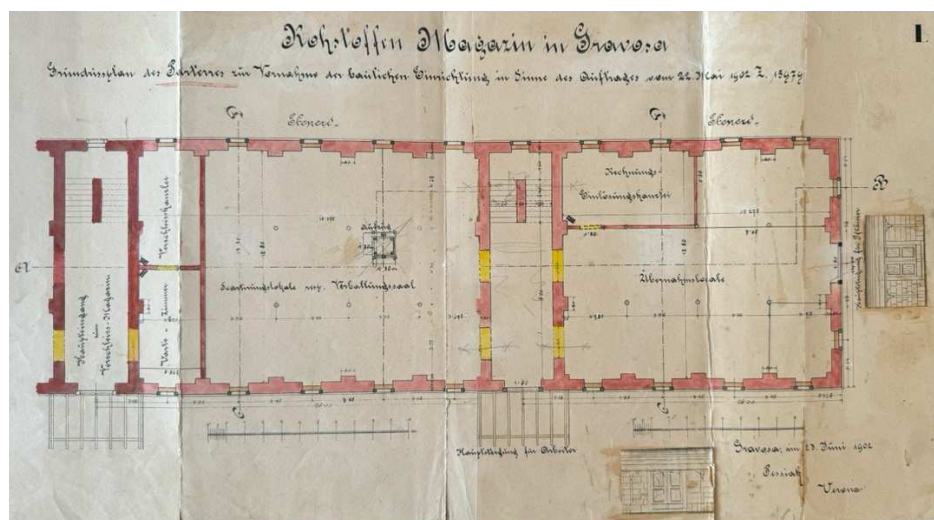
Adaptierungsprojekt, Tabaklager in Dubrovnik, Grundriss, 1902.
